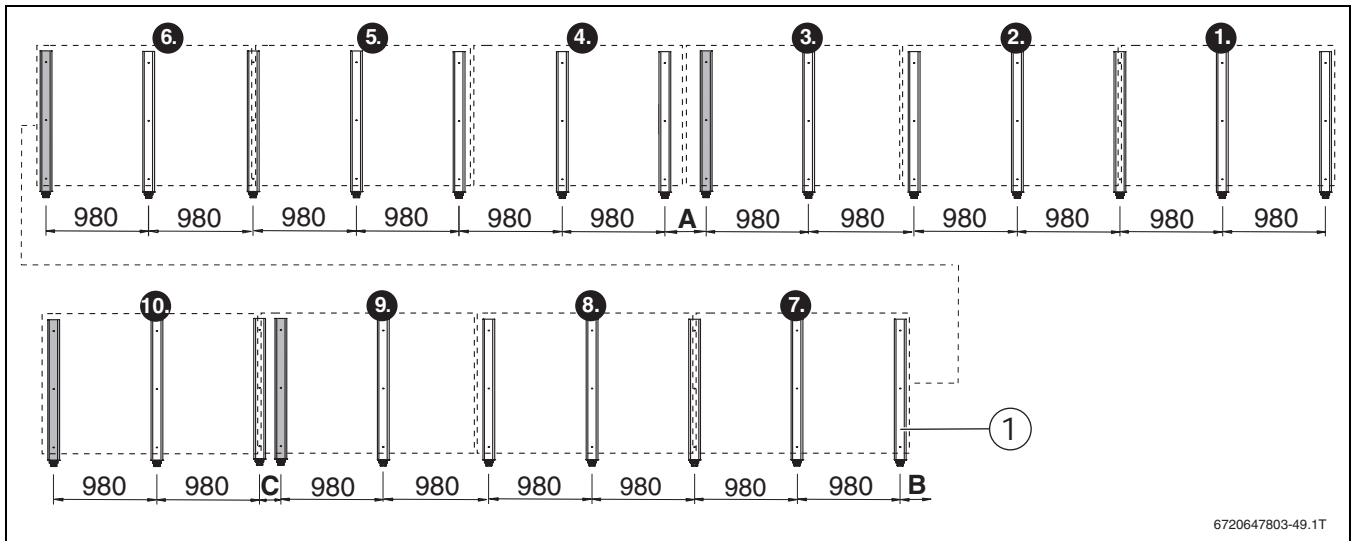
Základní provedení, 10 svislých kolektorů (údaje v mm)
